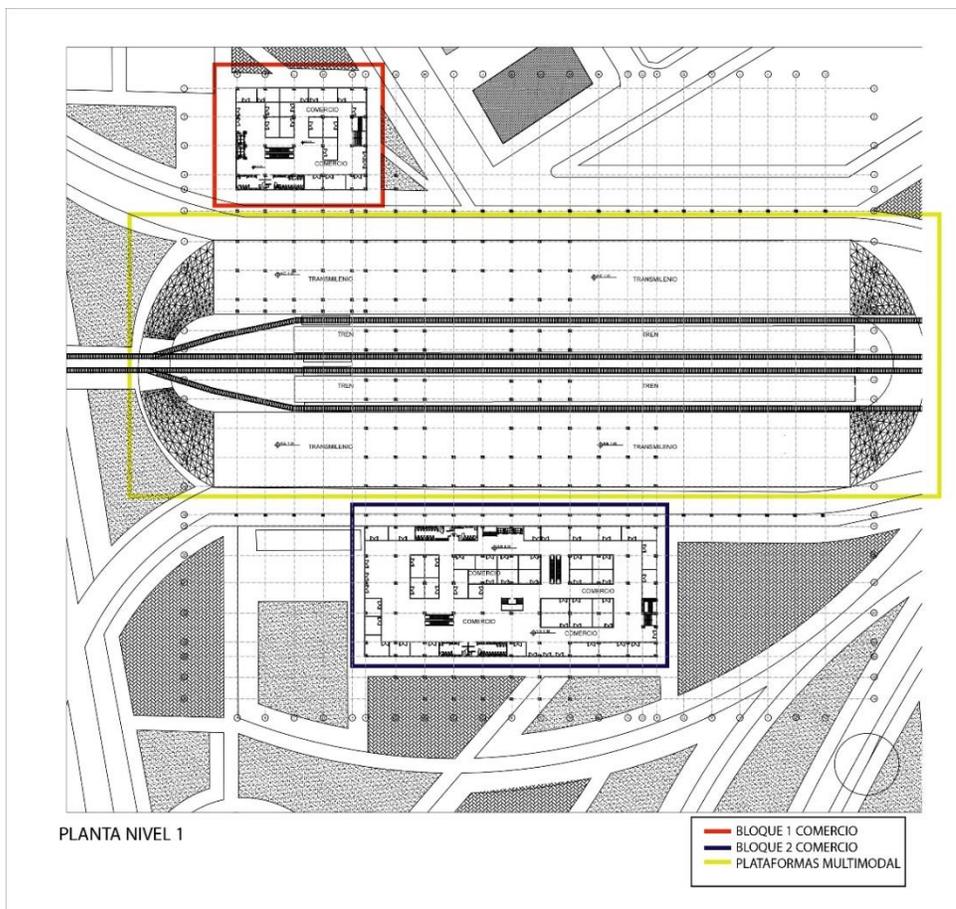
Planta zona comercial del primer nivel. Elaboración propia.
